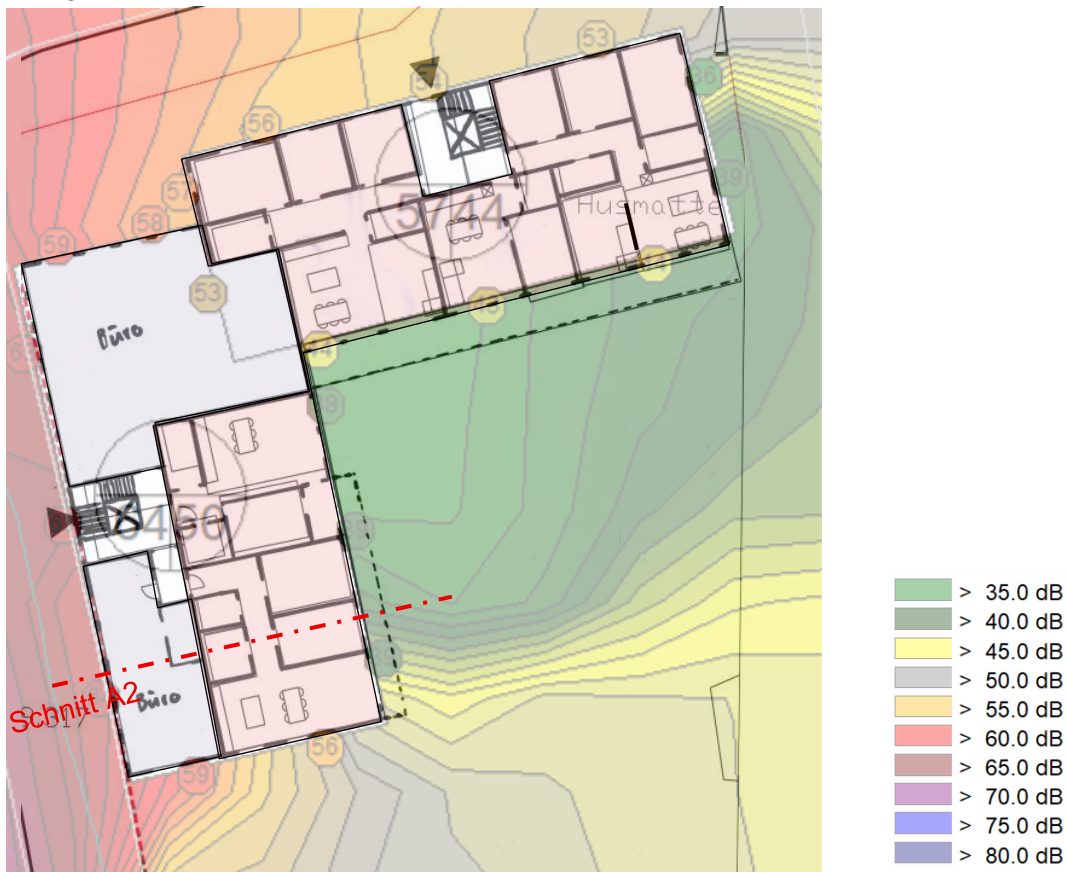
Grundrissoption Gebäude A1 und A2, 1.-3. OG
